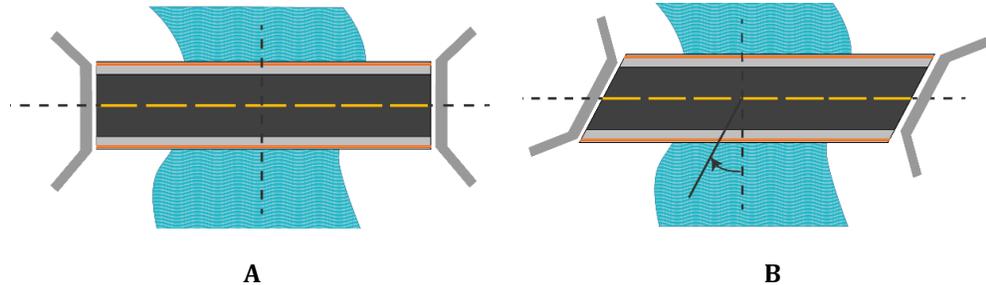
Esviaje en puentes, A. Planta de puente sin esviaje, B. Planta de puente con esviaje
